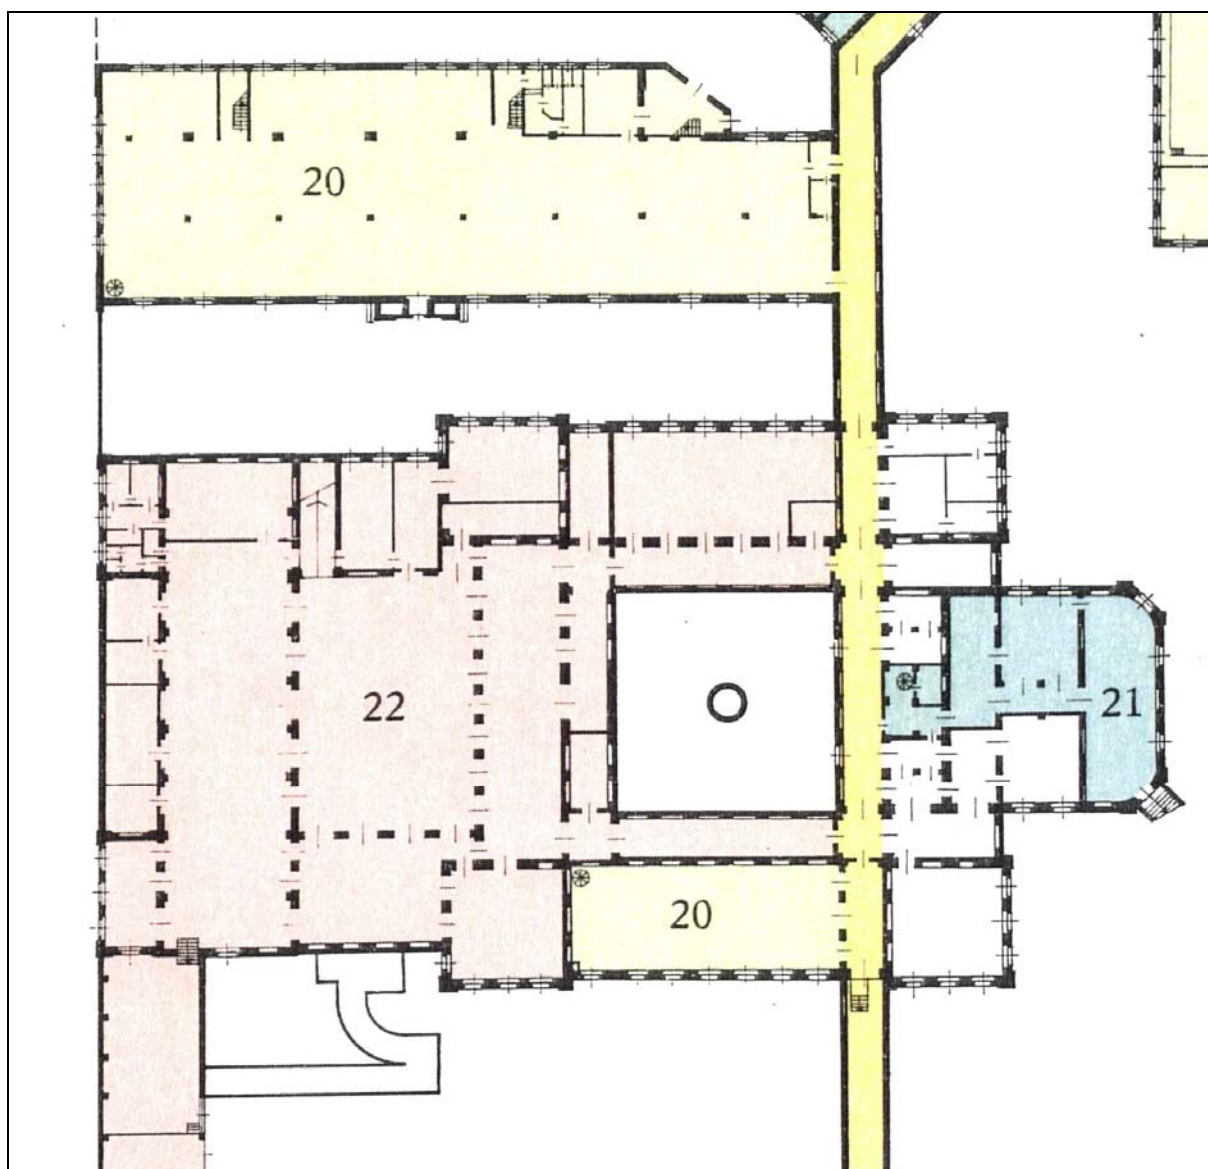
Planimetria del Piano Seminterrato ED 4 e ED 10 (1963)
